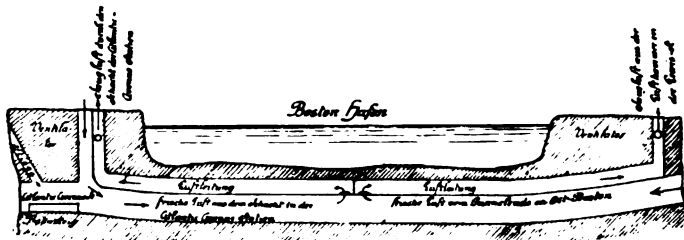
Lüftungsschema für den East-Boston-Tunnel.
